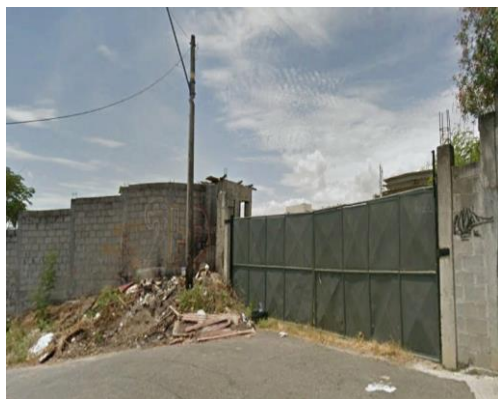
Imagem da Rua Califórnia com acesso ao terreno onde será instalado o anexo do empreendimento
